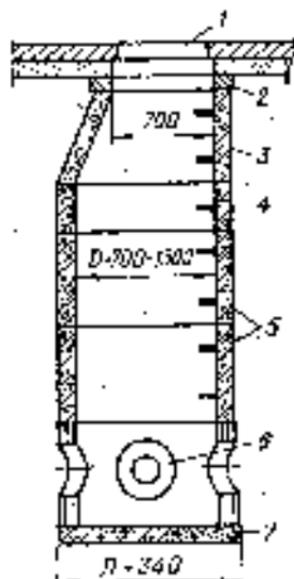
Колодец из сборного железобетона на водопроводной сети.
